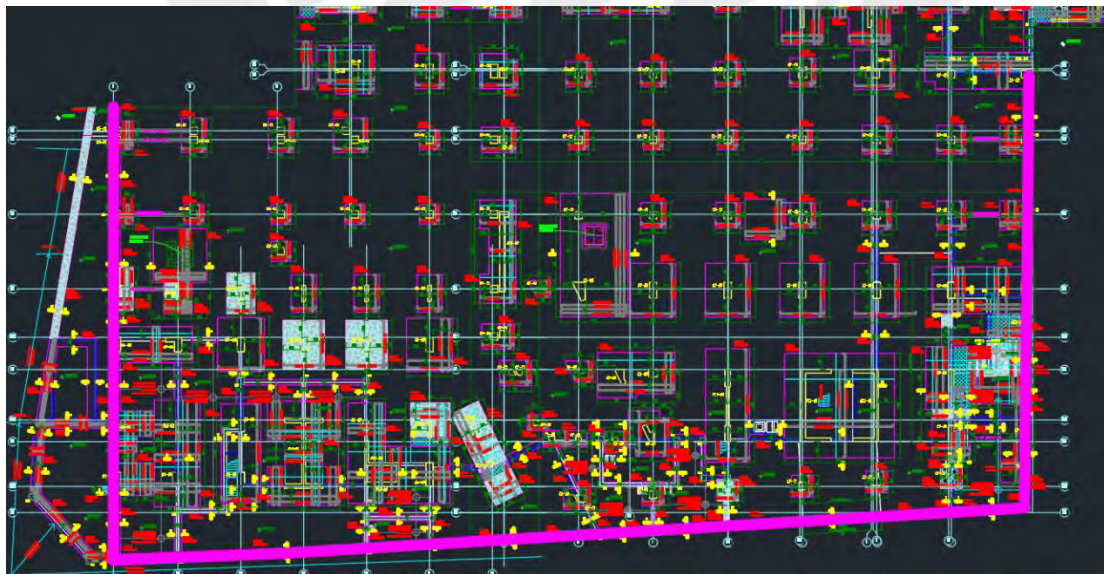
Plano en planta de cimentaciones y muros anclados de proyecto 2 Torres 1 y 4.
